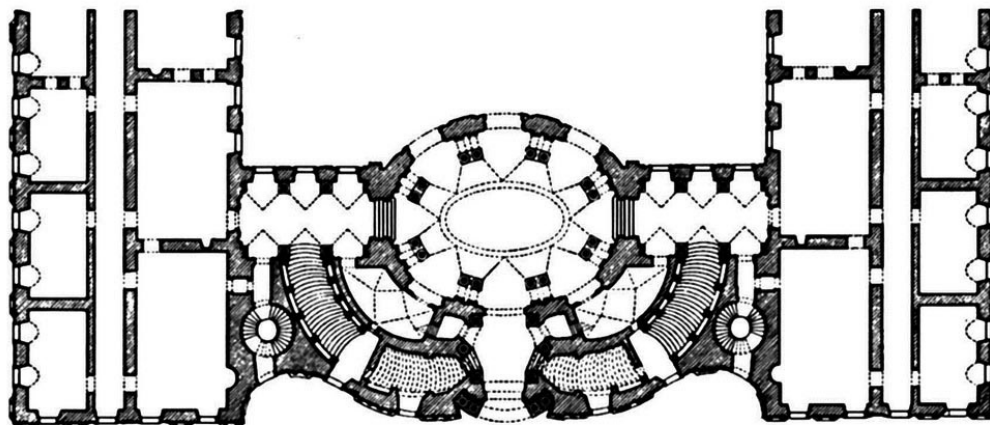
Planta del Palazzo Carignano. Fuente: Centro Vasco de Arquitectura.
